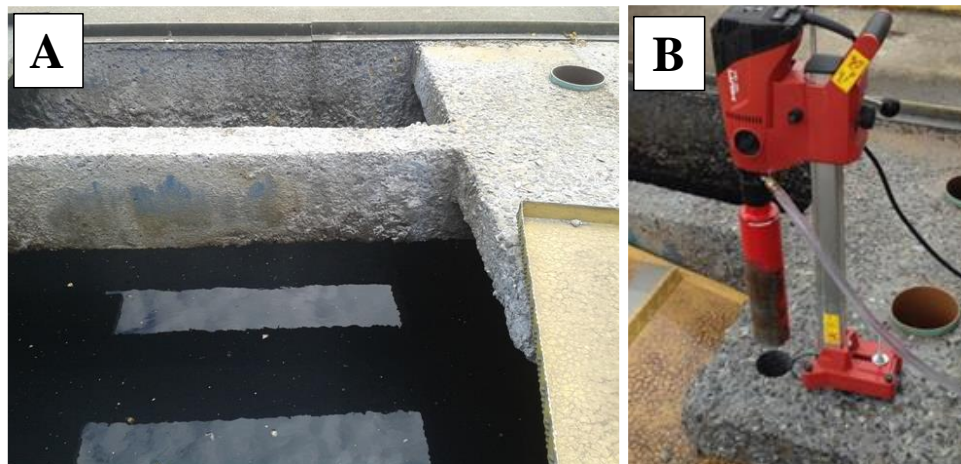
Local de extração do testemunho de concreto (A) e equipamento utilizado (B).
